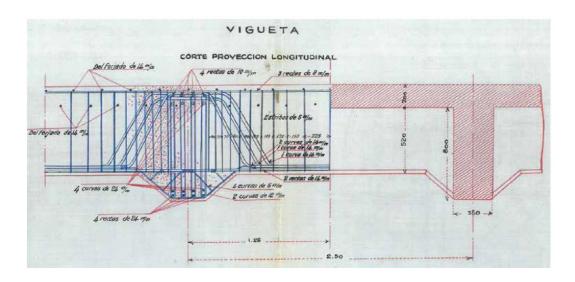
Plano original de las obras de reconstrucción del Muelle de Maura en los años 40 del siglo XX. Reproducido en [8].
